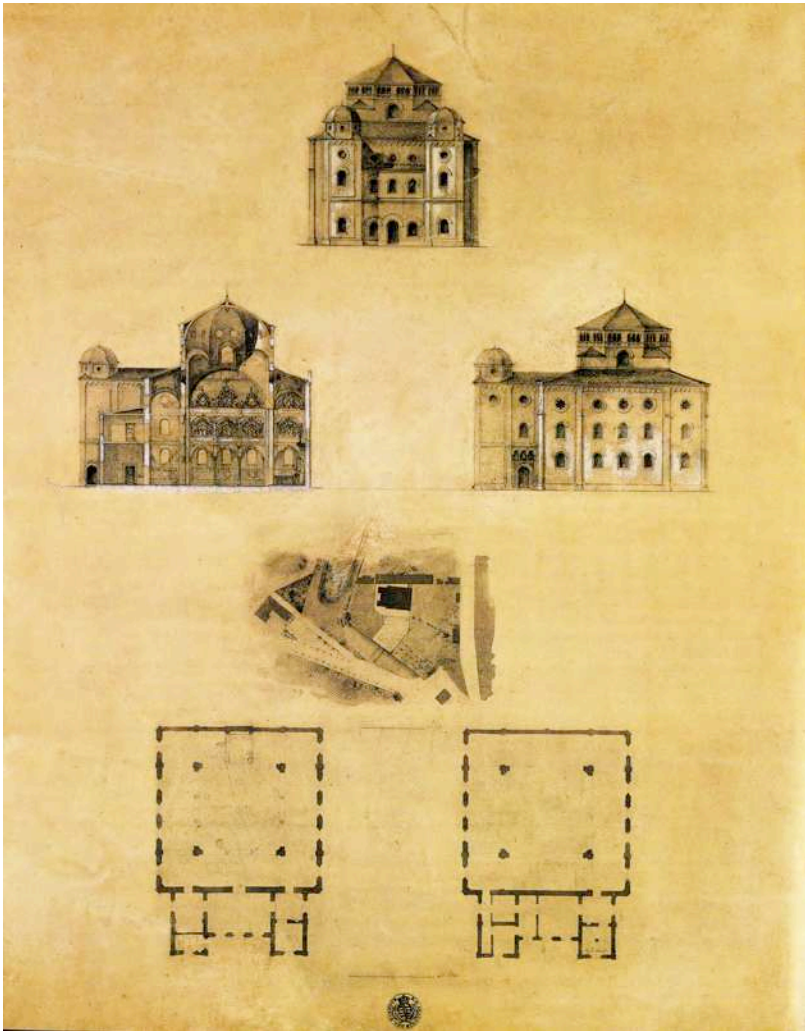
Gottfried Semper: Übersichtsblatt des zweiten Projekts der Synagoge in Dresden mit Lageplan, Ansicht Eingangsseite, Seitenansicht, Längsschnitt sowie zwei Grundrissen. April/Mai 1838, H. 53.8 cm, B. 44.4 cm. Bleistift laviert, weiss gehöht auf getöntem Papier. Standort: Archiv und Kustodie der Hochschule für Bildende Künste, Dresden
